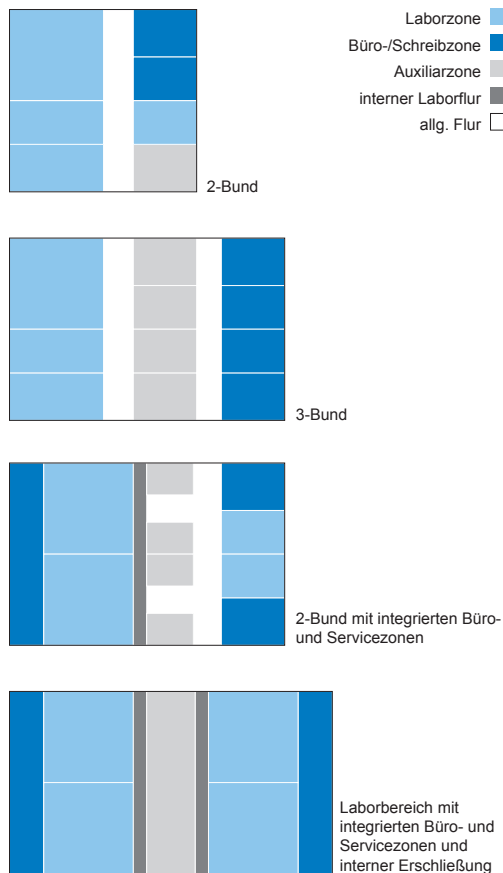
Grundrisszonierungen (Bsp.) für Laborgebäude [Cordes et al. 2007]
